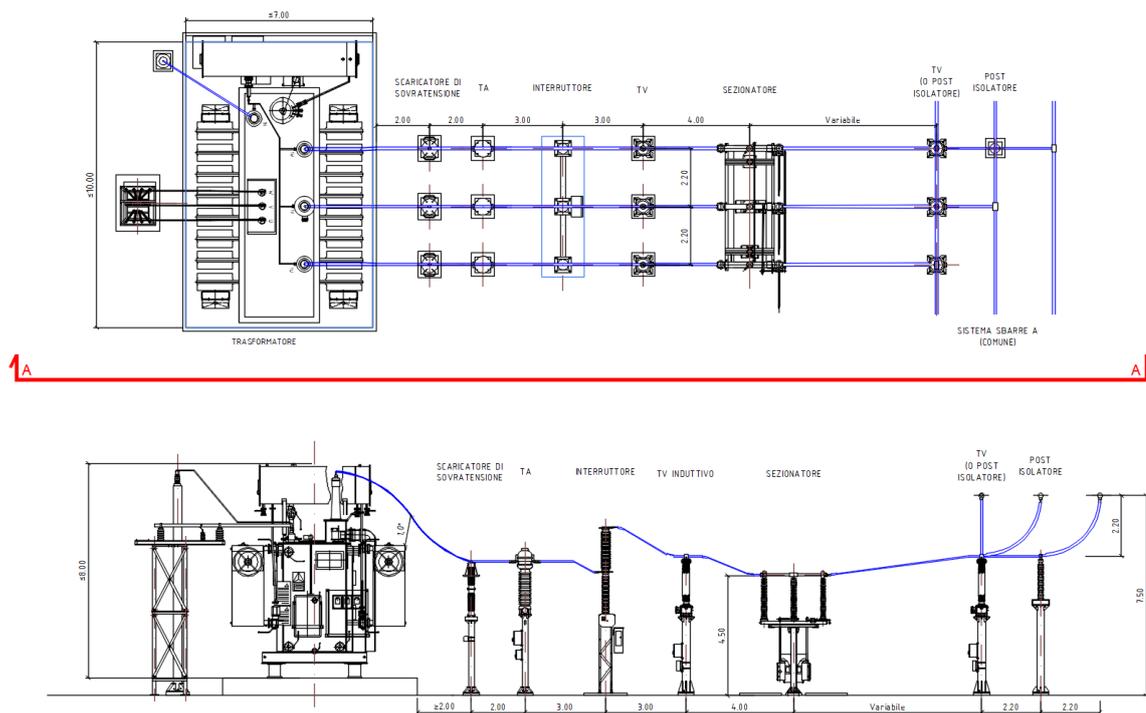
Planimetria e sezione stallo di trasformazione 150/30 kV
